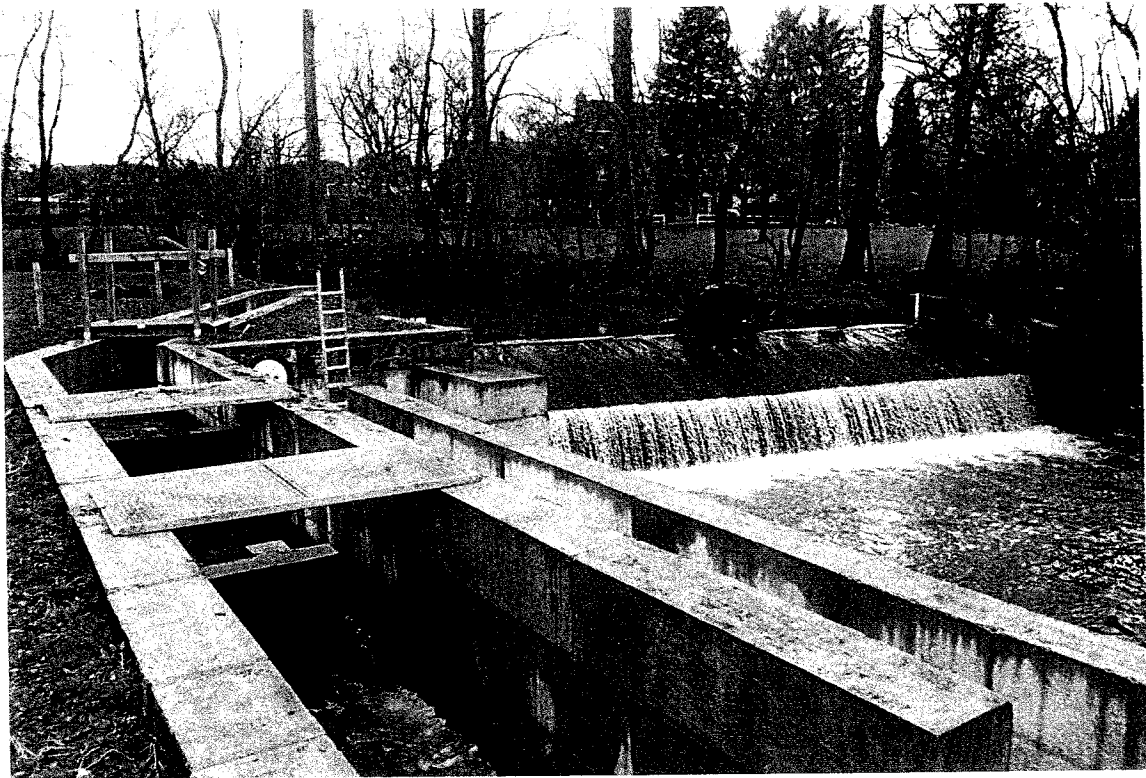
/7. Vue de la nouvelle échelle à poissons construite en 2004 au barrage de Mortroux sur la la Berwinne.
